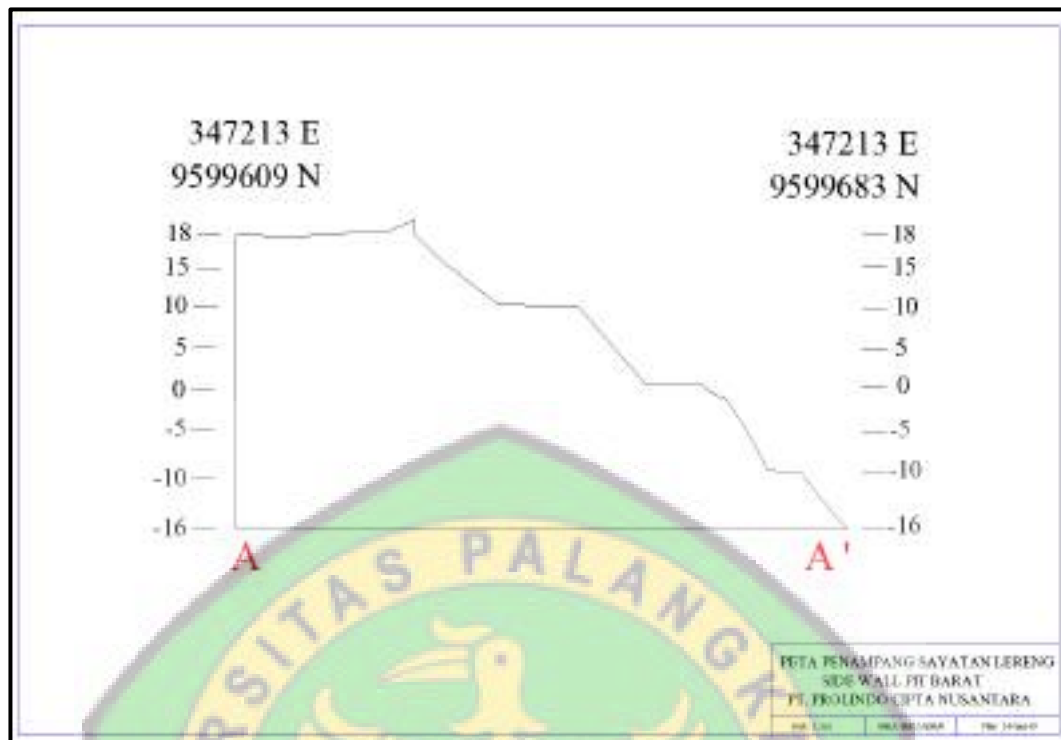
Cross Section A-A' Lereng Sidewall Pit Barat
